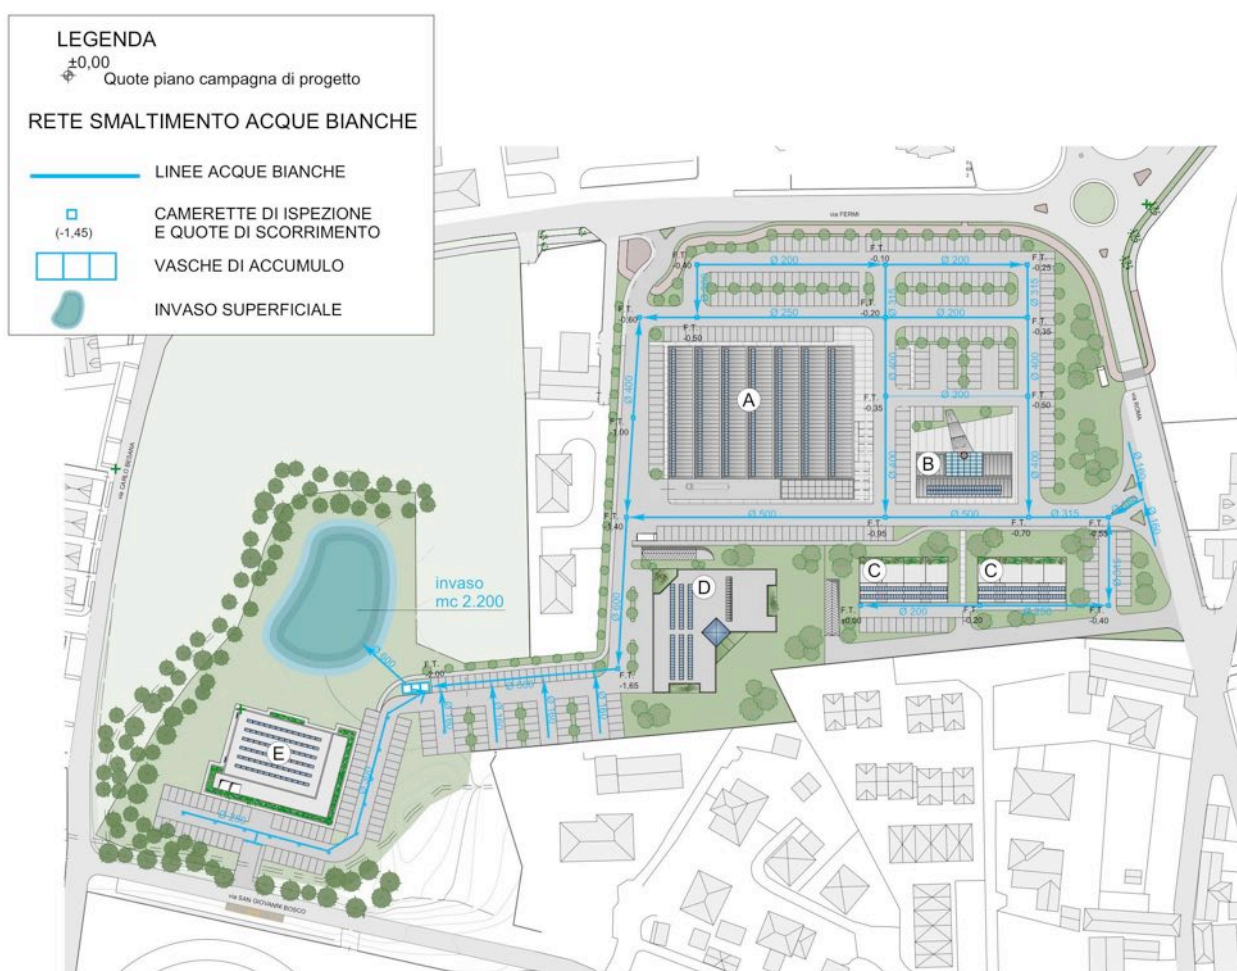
Rete acque bianche di progetto (Fonte Progetto PII tavola 4 e tavola 13)
